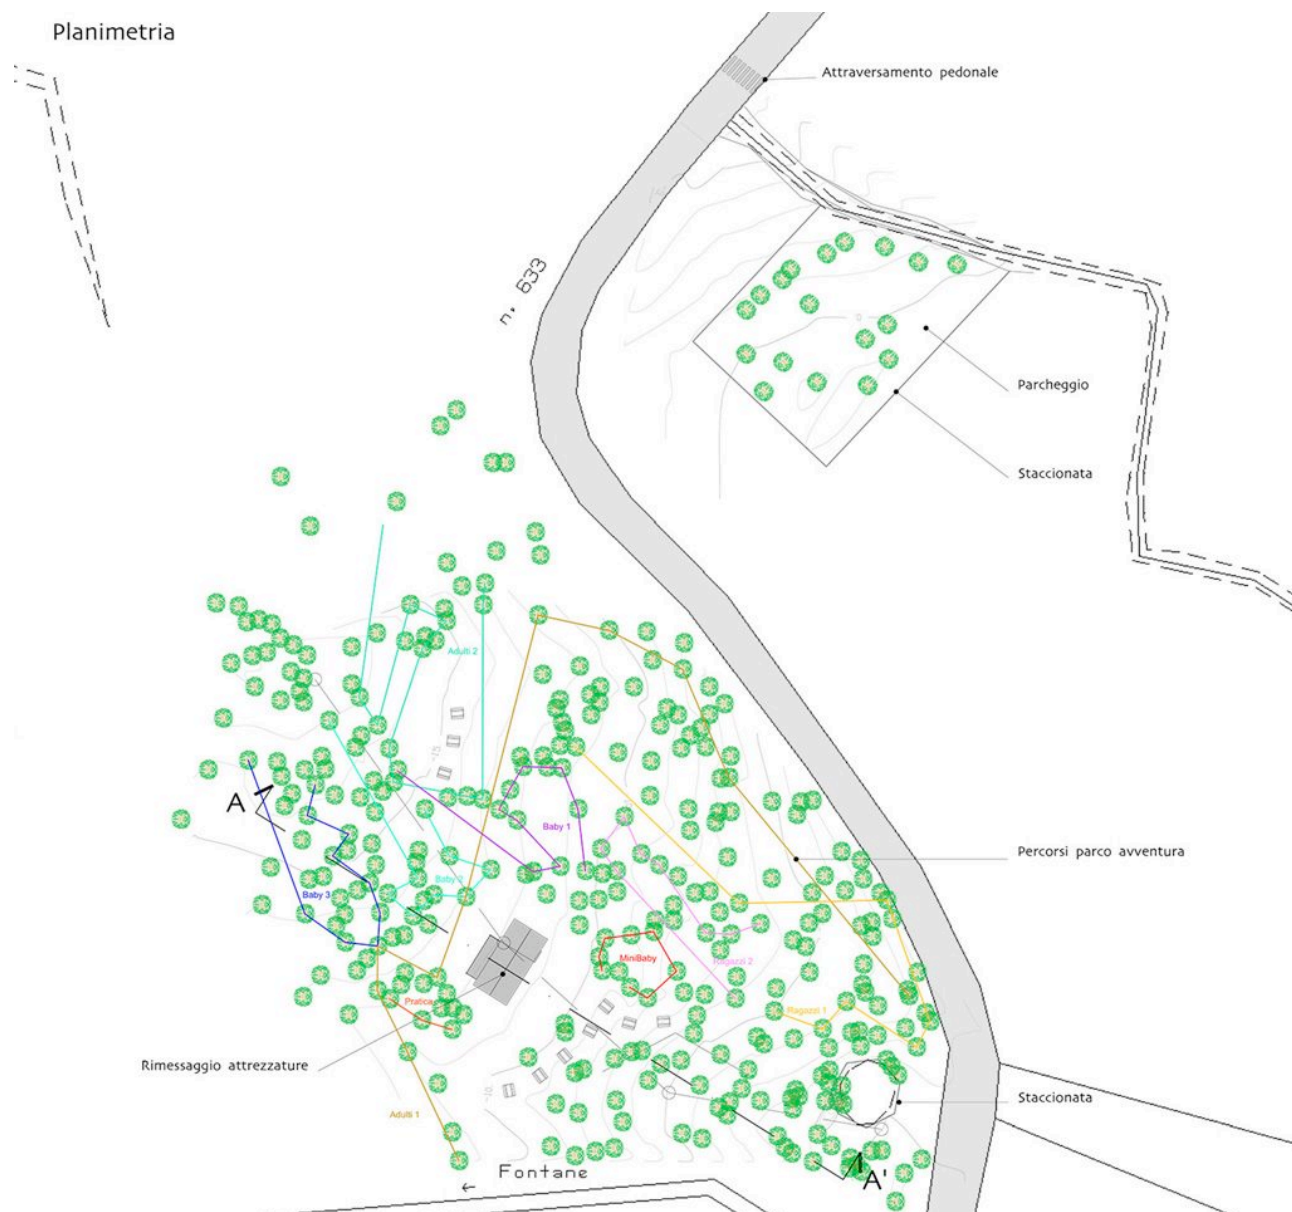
Planimetria generale di progetto (per la tavola completa si rimanda all'allegato "E") con indicazione delle installazioni del parco e del parcheggio.
